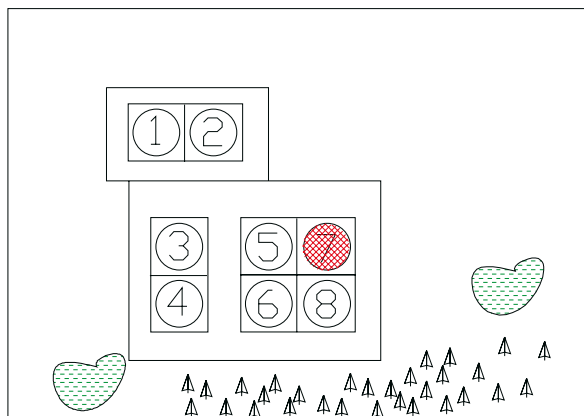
Схема расположения резервуаров в резервуарном парке.
